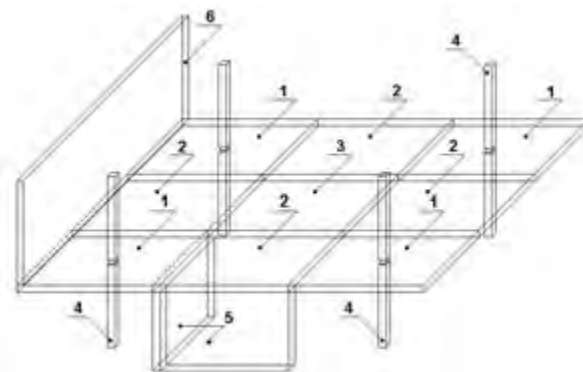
Схема конструкции безригельного сборно-монолитного здания
